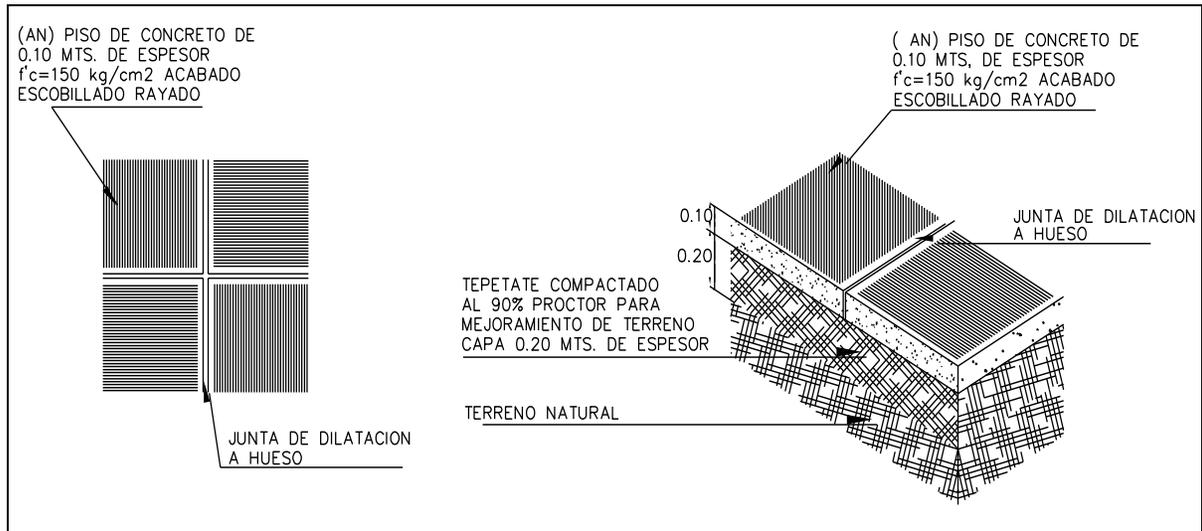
Detalle de junta de dilatación en piso ó banqueta.
